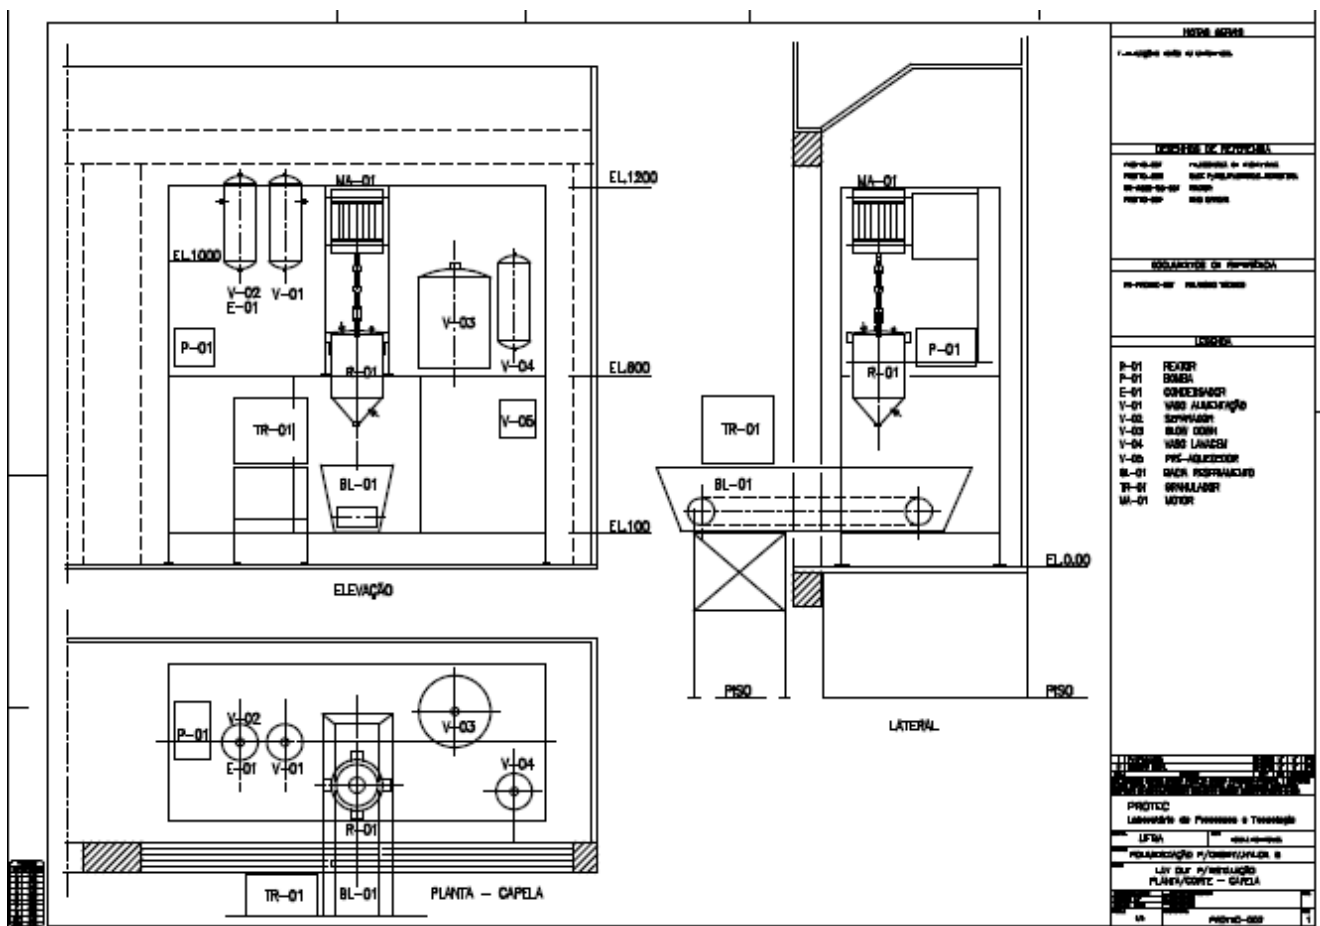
LAY OUT de Instalação da planta piloto na capela.
